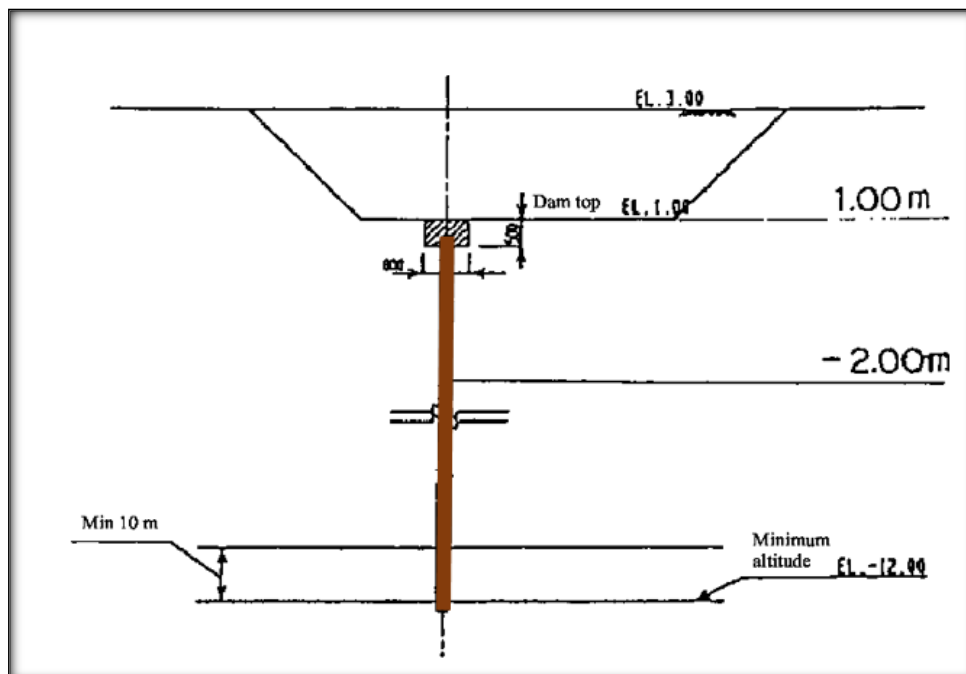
Vue sectionnelle du mur de coupure au barrage de sous-surface de Senbaru
